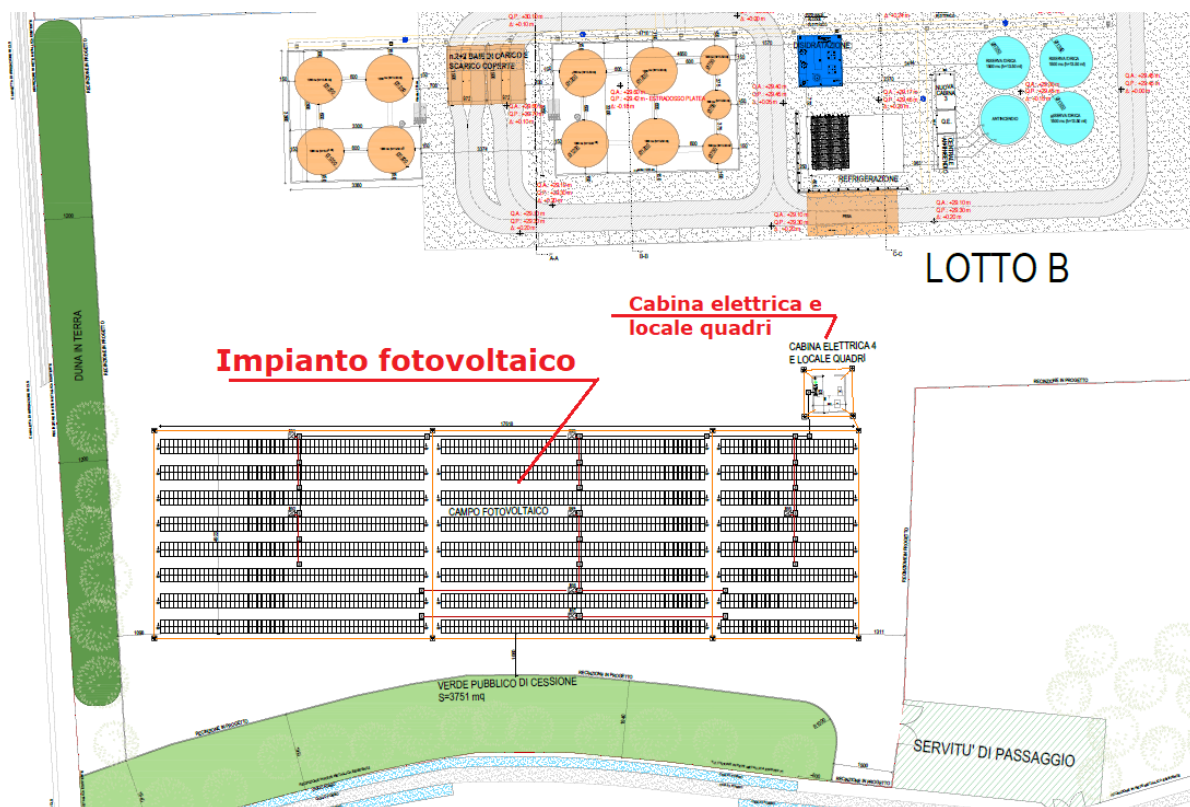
stralcio planimetria di progetto con indicazione del nuovo impianto fotovoltaico e sistemazione del verde
